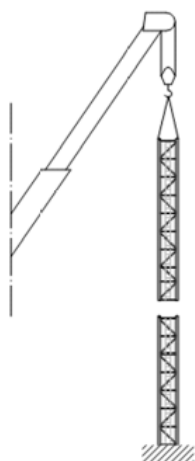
Colocación de los tramos de mástil con grúa telescópica
